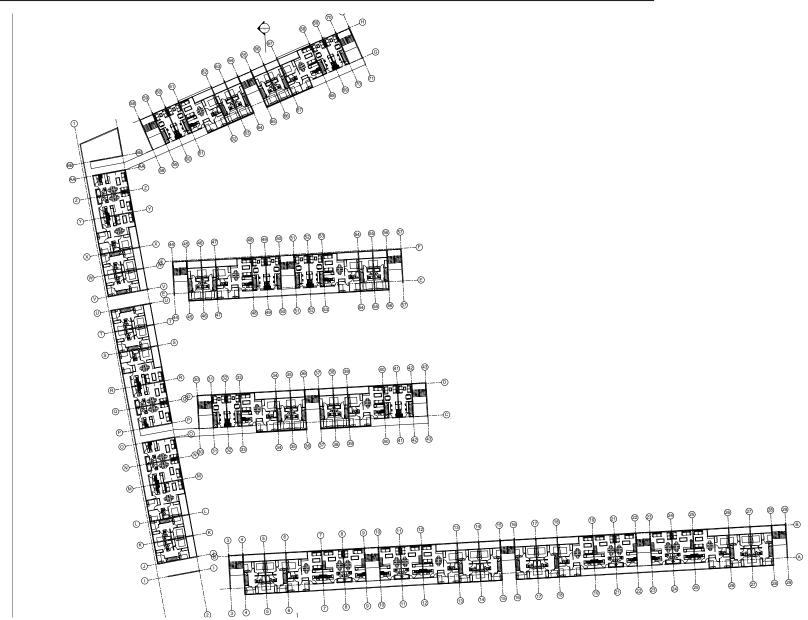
Planta Tipo Pisos 4, 6, 8 y 10. Fuente: Elaboración propia.
